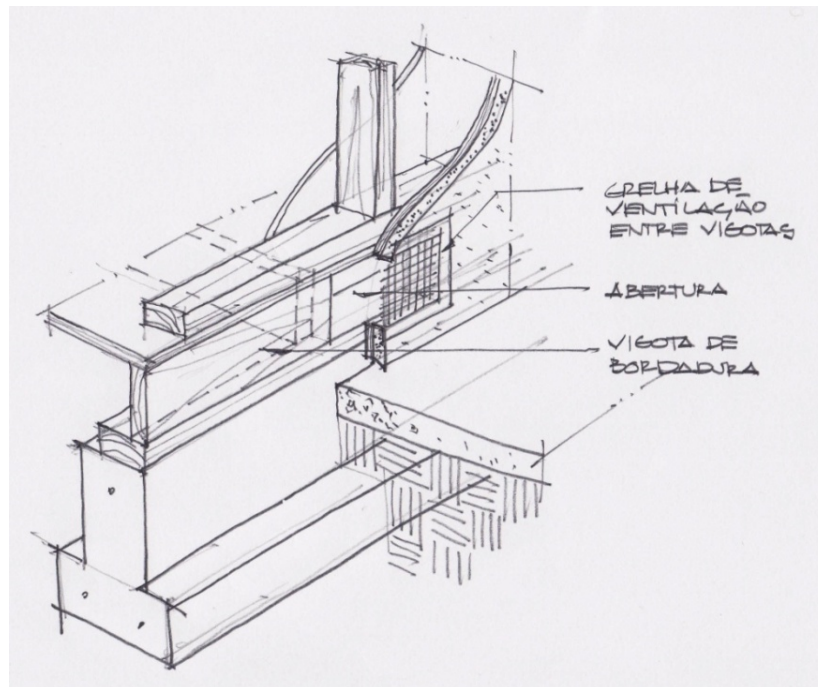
Grelha de ventilação do vazio sanitário colocada entre vigotas de pavimento. (des. autor)
